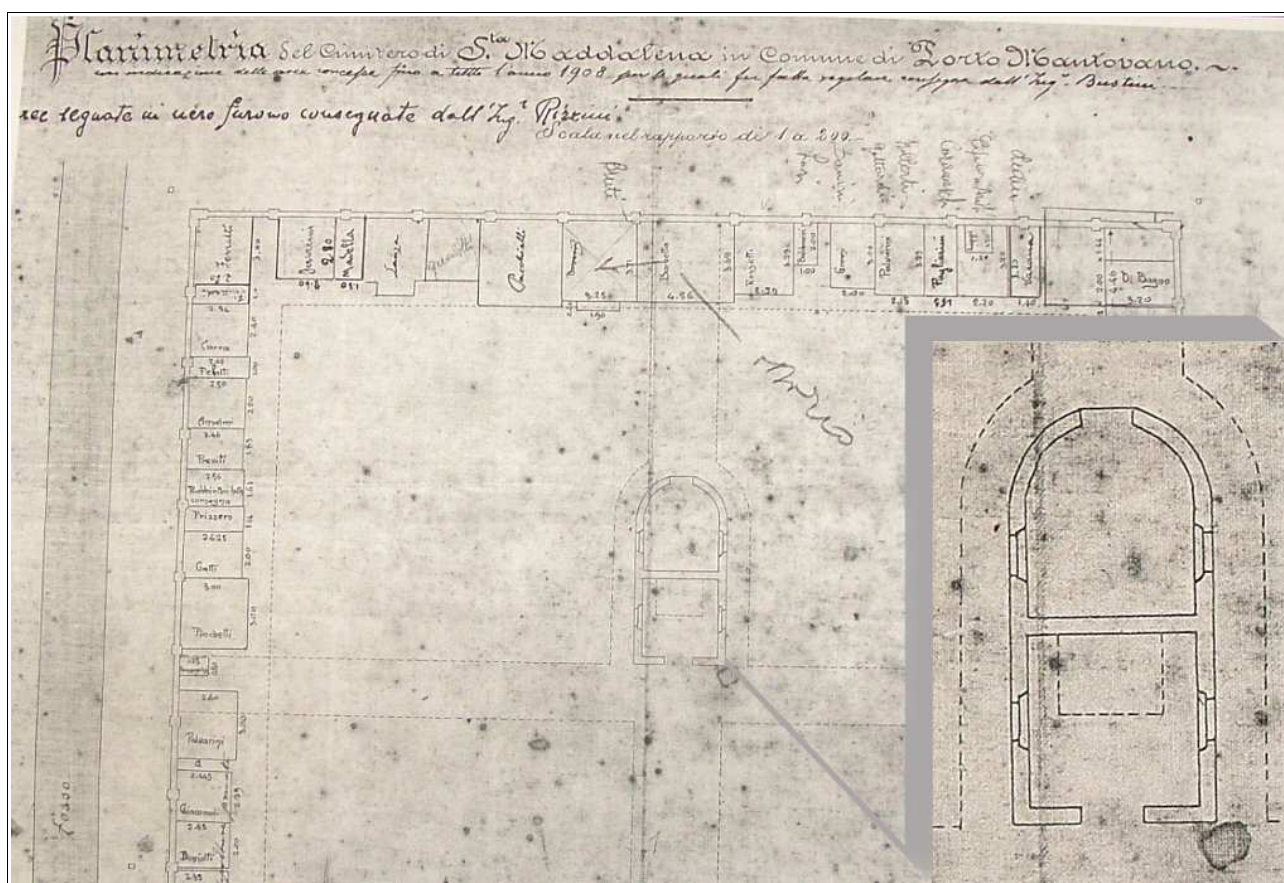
Estratto planimetria generale del cimitero di S. Maddalena – anno 1908
